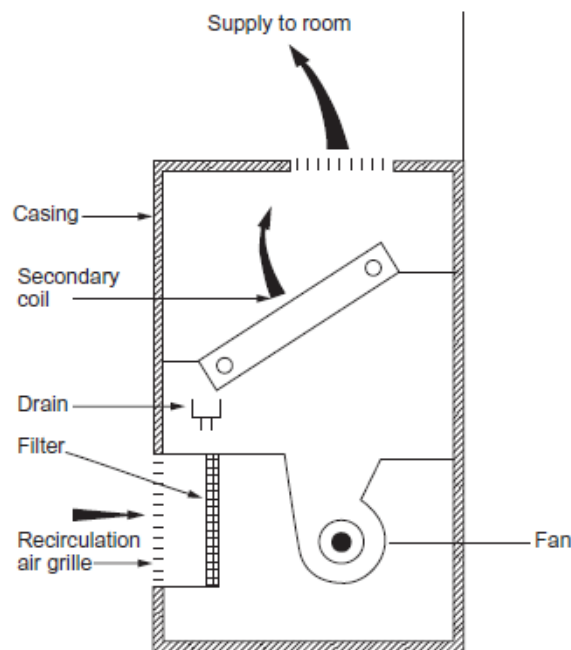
Schema costruttivo ventilconvettore a pavimento [8]
